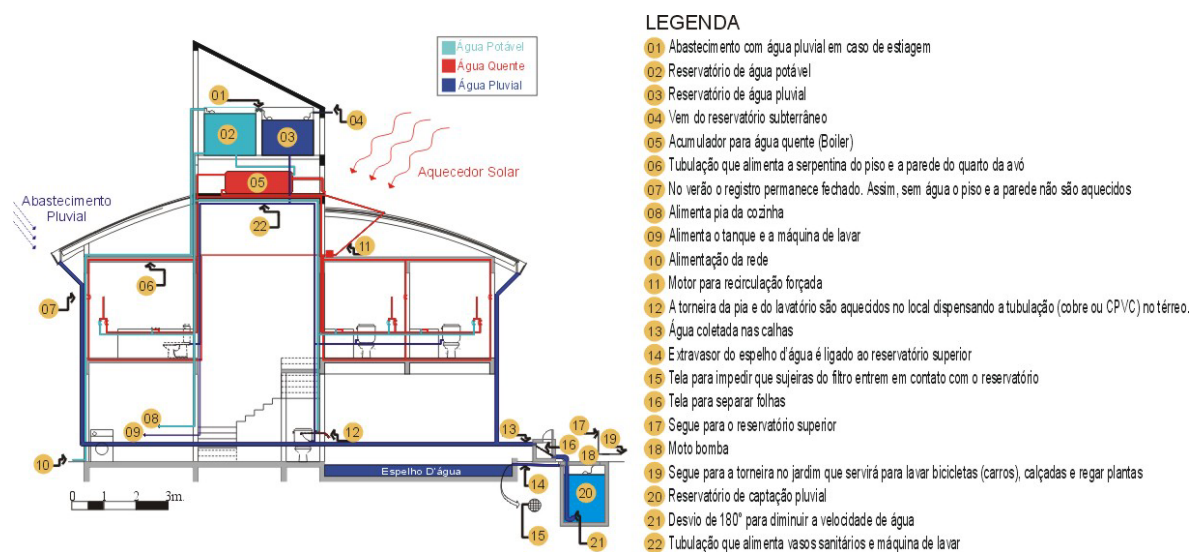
Corte CC (Esquemático do Sistema Hidrosanitário)
